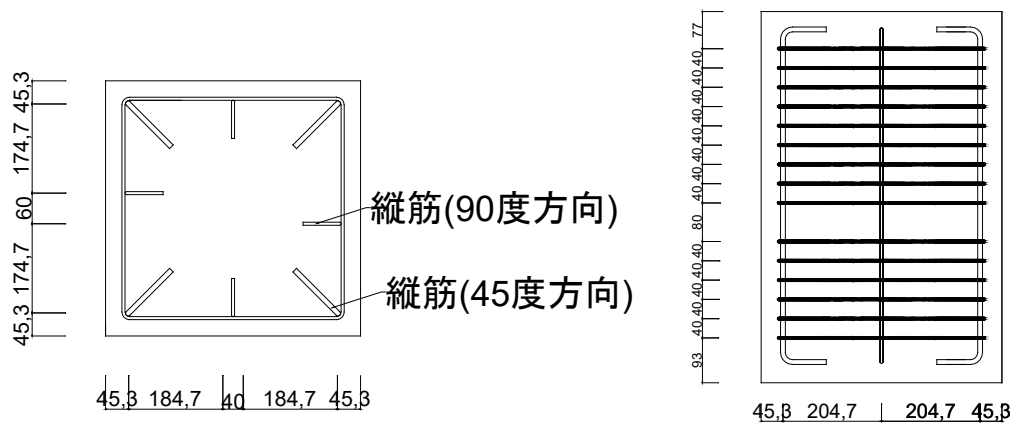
試験体 A-7a 断面詳細図パイルキャップ
